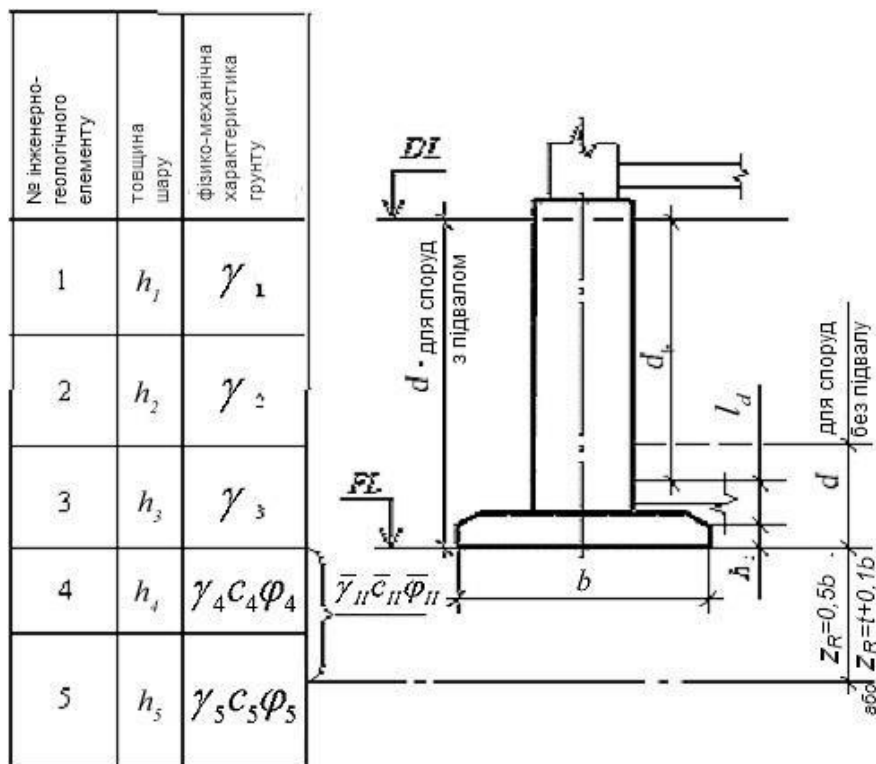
Схема розрахунку розрахункового опору ґрунту
